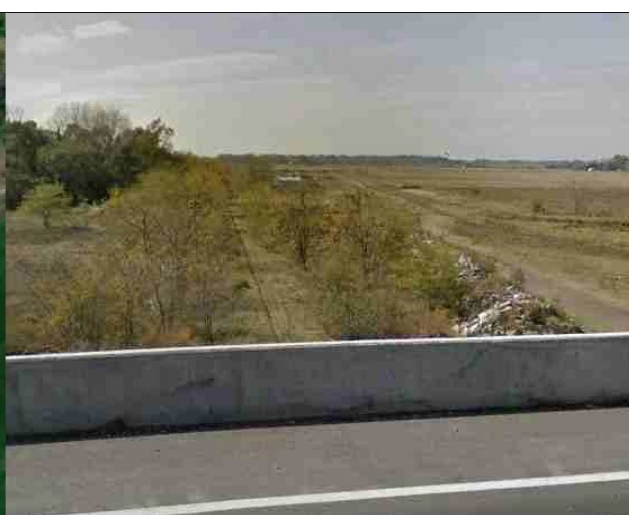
y Foto 225. Intersección RP N°6 Ferrocarril Gral. Belgrano
